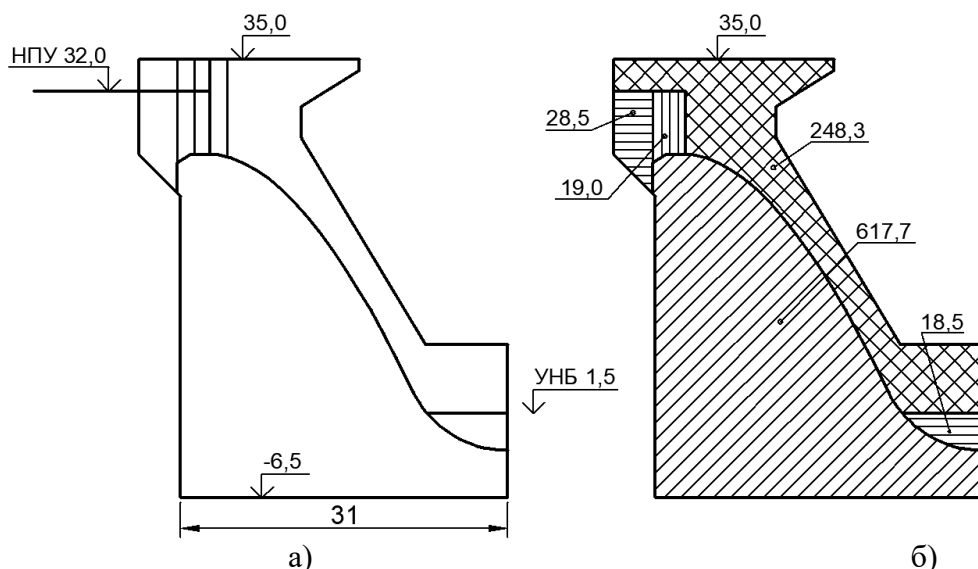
Исходные данные к расчёту нагрузок на бетонную водосливную плотину
